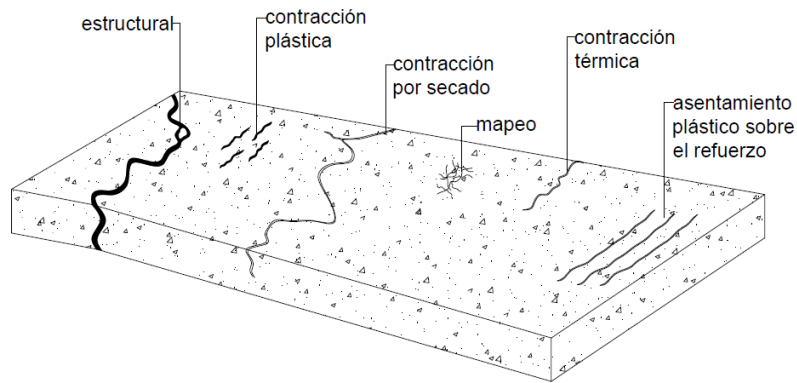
Tipos de fisuras que pueden aparecer en losas sobre el suelo.
